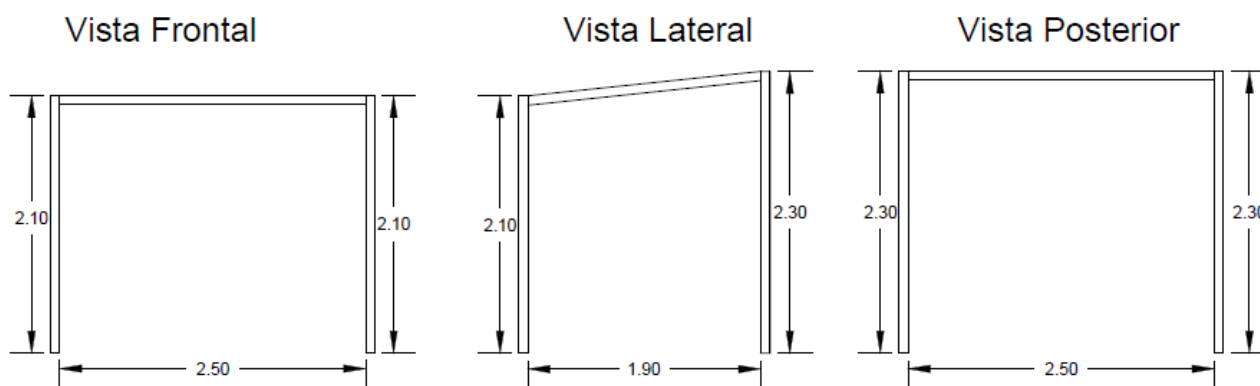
Sistema de perfiles para cubierta PTAP.
